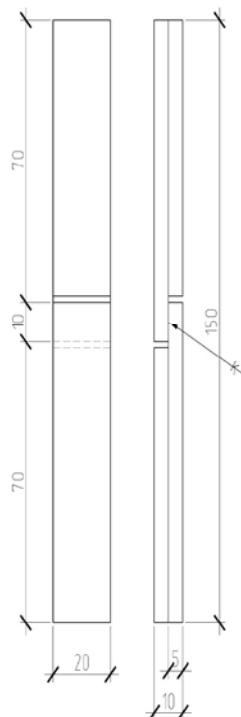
Форма и размеры образца для испытаний по растяжению вдоль волокон
